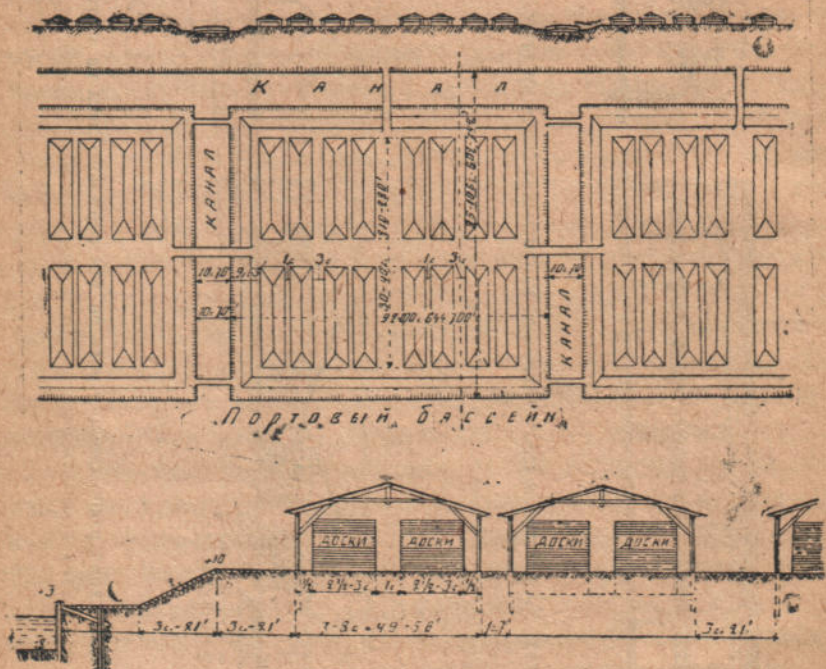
Схема общего расположения навесов для сортового леса на портовой территории. Вверху — прод. разрез и общий план; внизу — деталь части прод. разреза.
